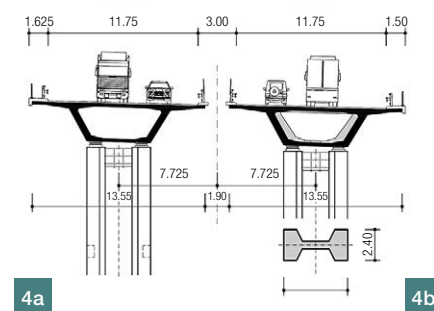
Příčný řez mostem: a) uprostřed rozpětí, b) u podpěry ■ Fig. 4 Cross-section of the bridge: a) at mid-span, b) at support
